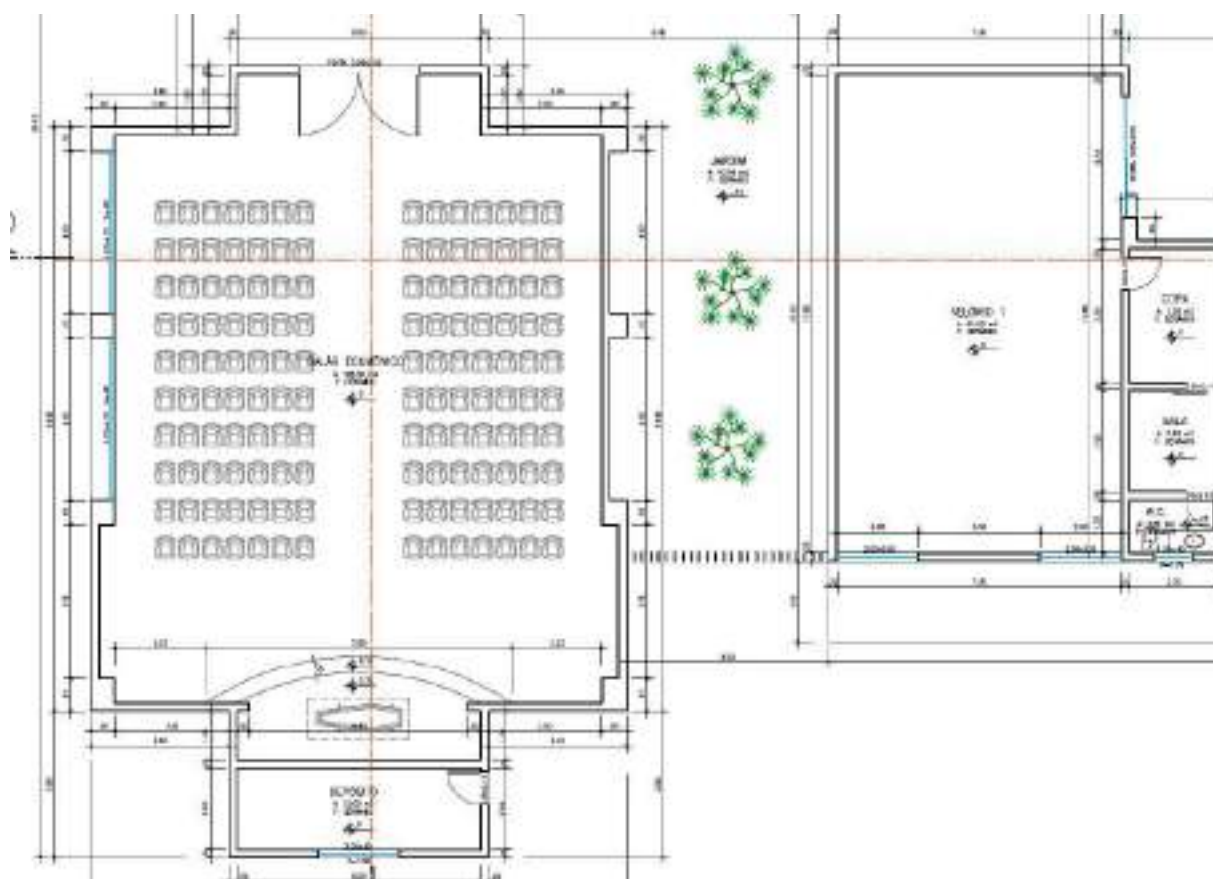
Partes da planta baixa geral da infraestrutura do velório.
